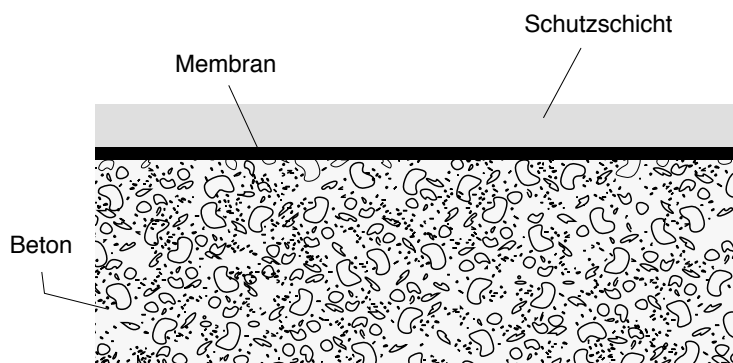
Membrandichtung auf Betondecke mit Schutzschicht
